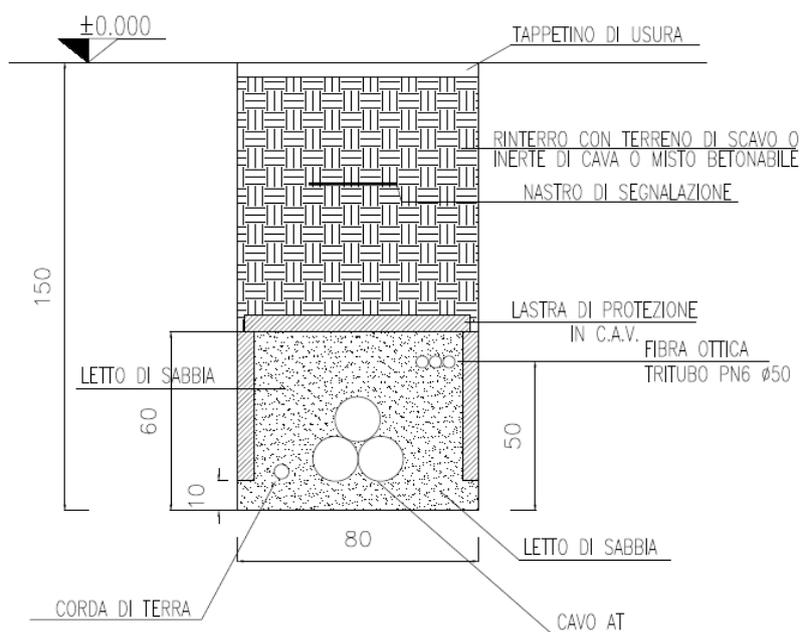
Sezione di posa AT. Per maggiori dettagli riferirsi all'elaborato 'MOL1.67 – Planimetria cavidotti e tipici di posa'.
